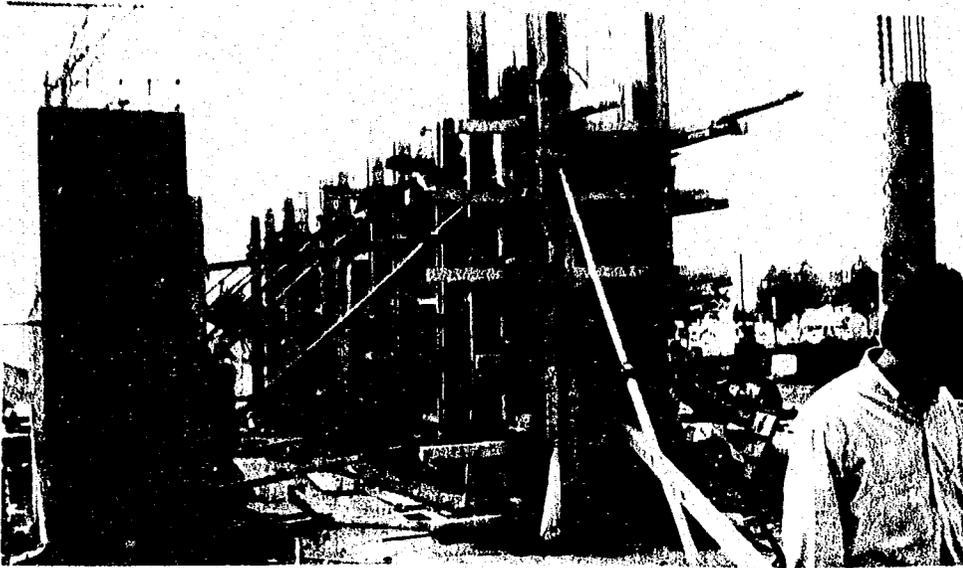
Cimbra de madera para la construcción de un muro de las escaleras del metro de la línea B
